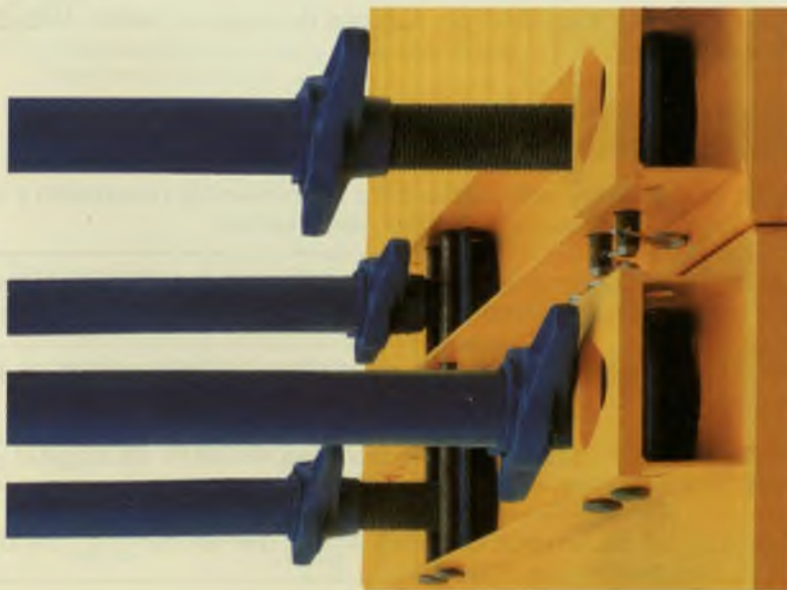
Apoyo elástico de los codales sobre las planchas de blindaje
